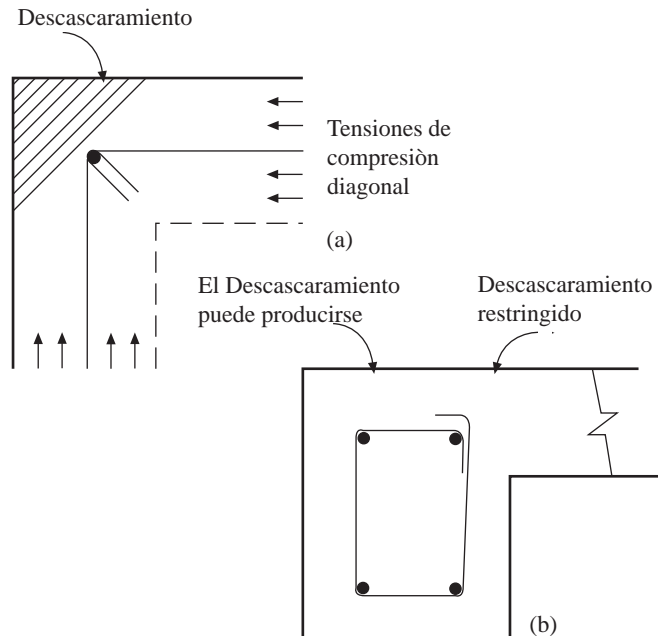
Descascamiento en esquinas de vigas cargadas en torsión.
